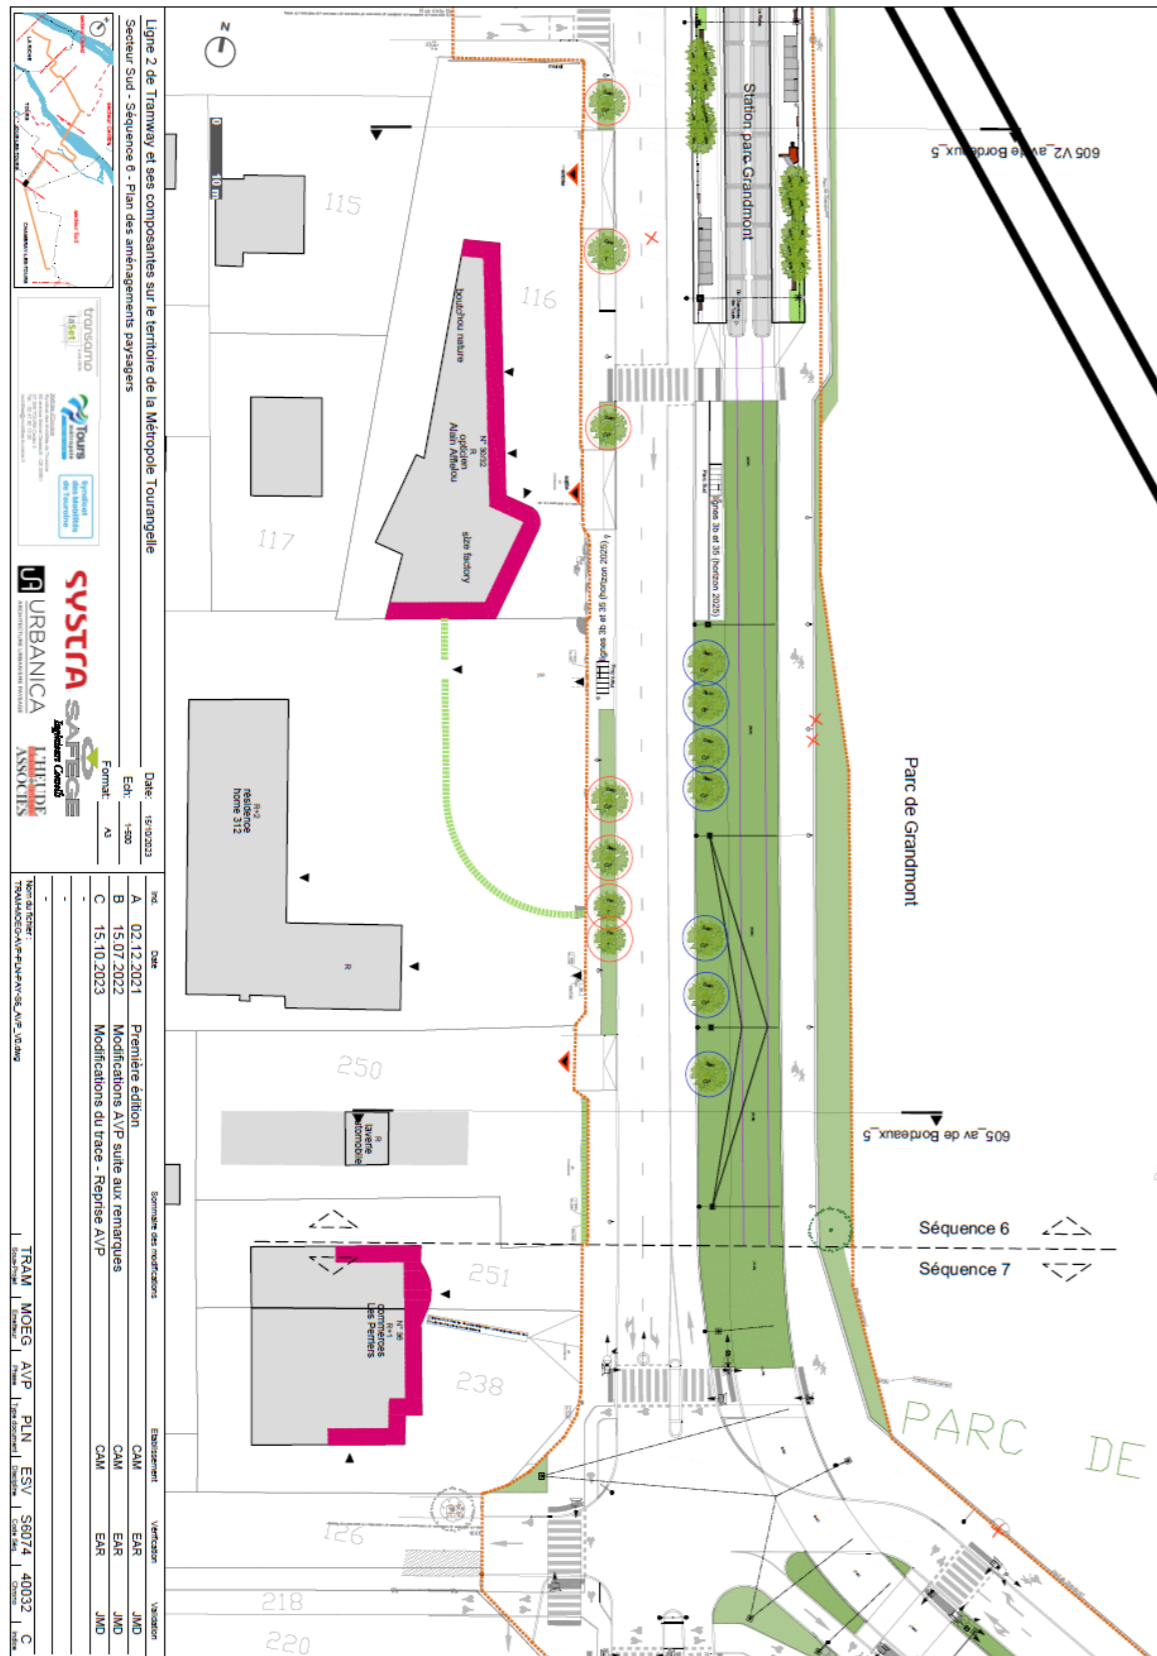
planche E – Avenue de Bordeaux – Parc de Grandmont – Tours
